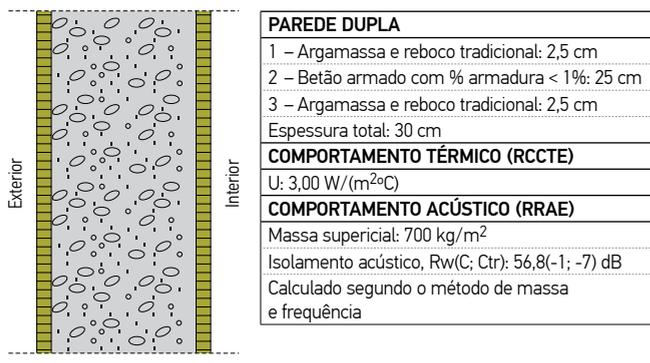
Pormenor da ponte térmica plana da parede exterior
